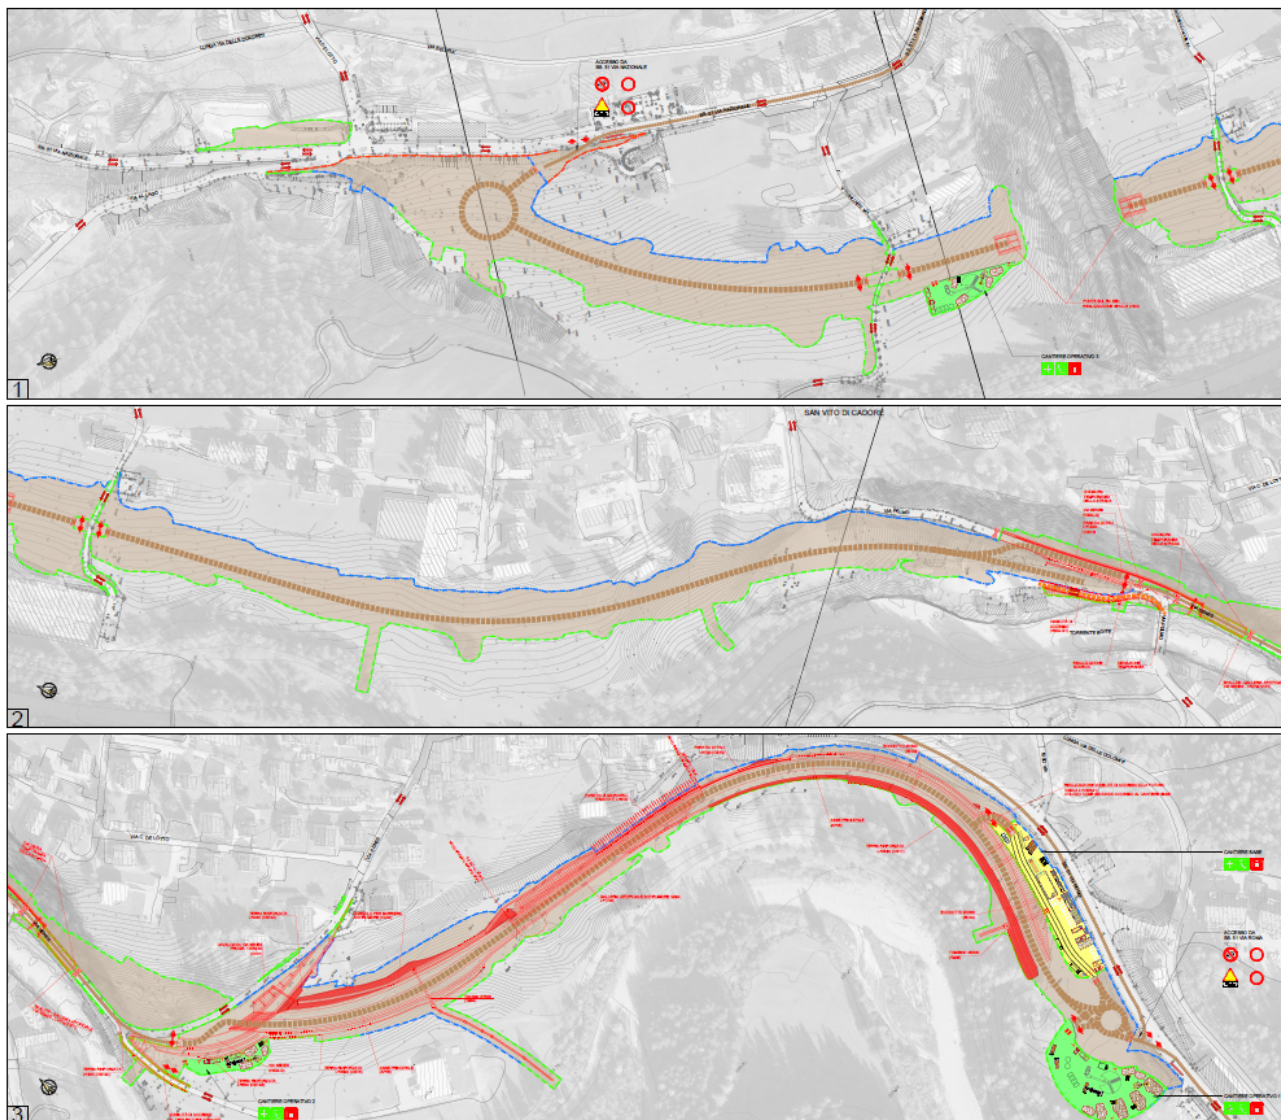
Tavola delle fasi in cui si vede l'impiego prevalente del nuovo tracciato in progressiva costruzione come pista di cantiere.
